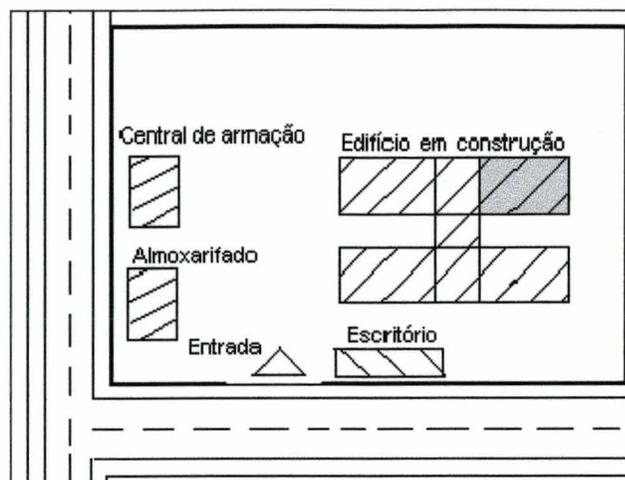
Layout* do canteiro da laje com painel treliçado.
